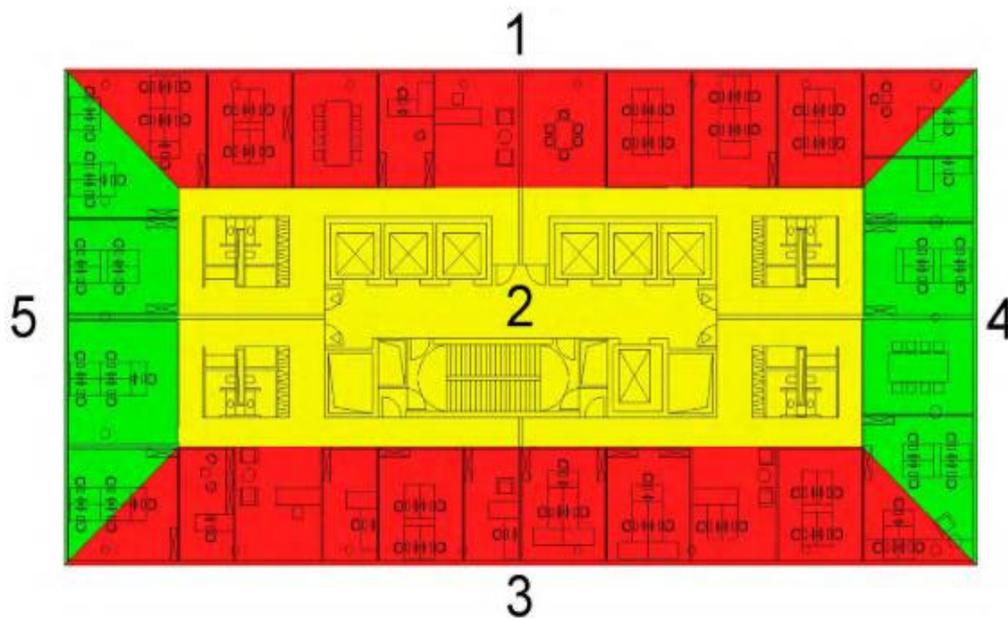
Zonierung des Grundrisses im IG-Tool (Reiß et al., 2011)
